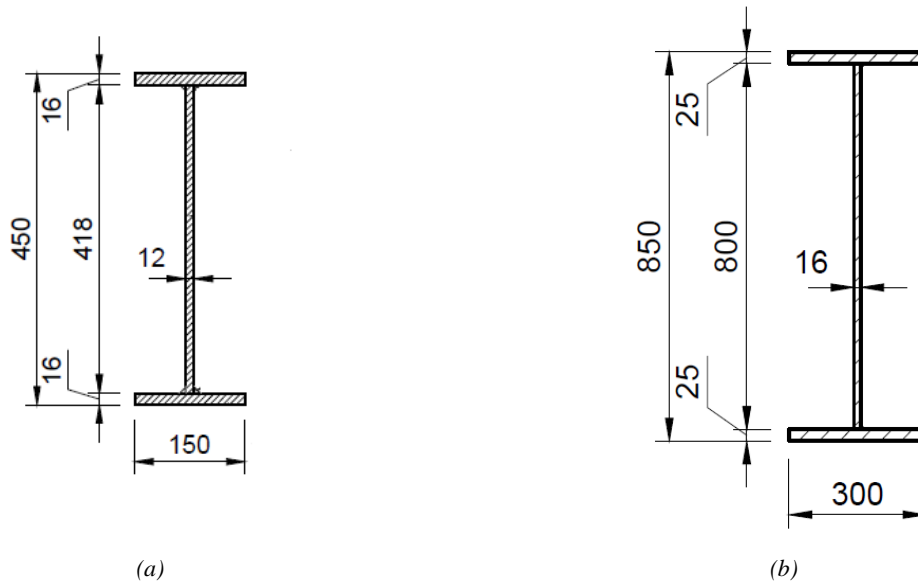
Vigas en apoyo - (a) Puente entre unidades; (b) Puente de acceso
